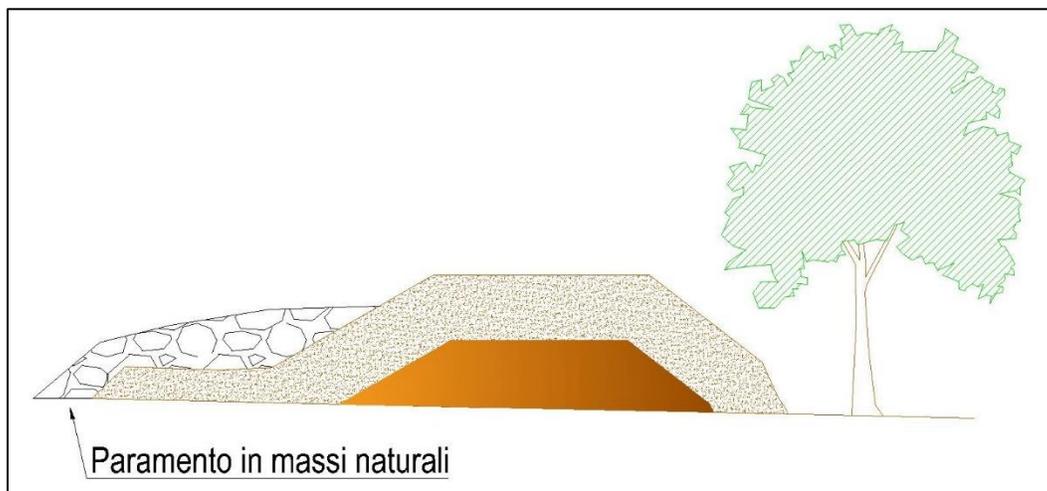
Sezione Tipo del solo rilevato arginale
